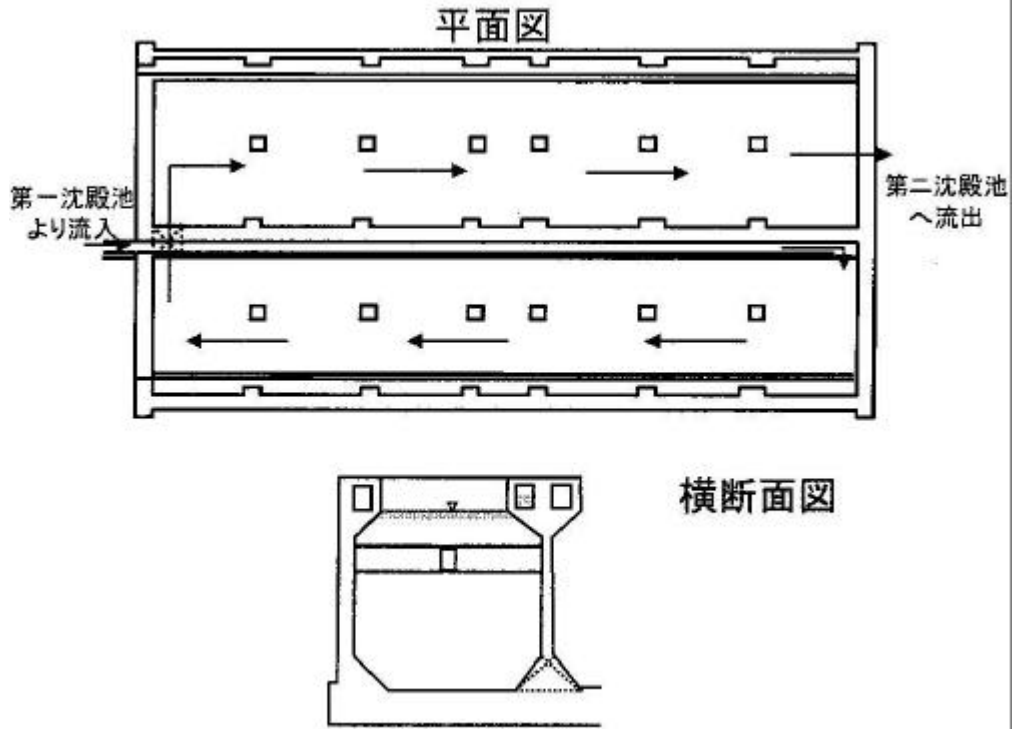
曝氣池平面圖及橫斷面圖
